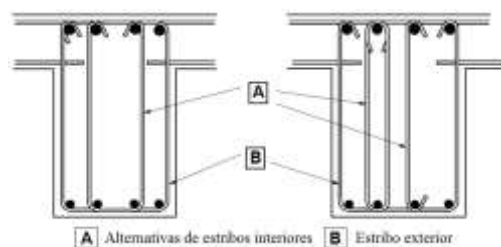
Exemplos de armaduras de esforço transversal [5].
